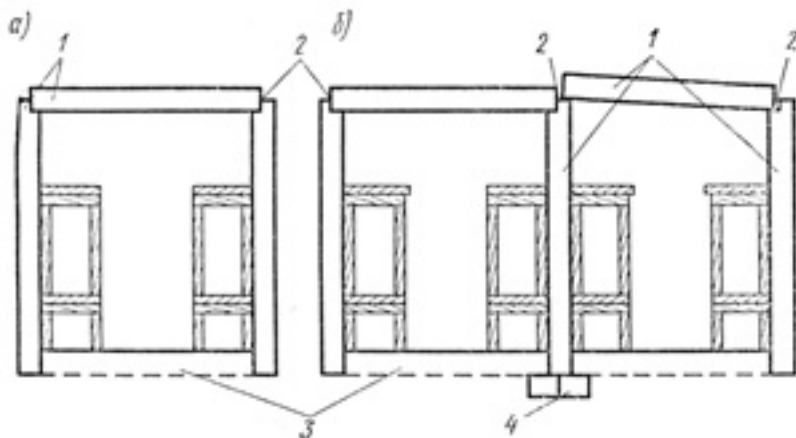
Конструктивные решения убежищ из железобетонных элементов, изготовленных в существующей оснастке: а) – однопролетное; б) – двухпролетное; 1 – элементы стен и покрытия; 2 – сварка через закладные части; 3 – распорки; 4 – фундамент
